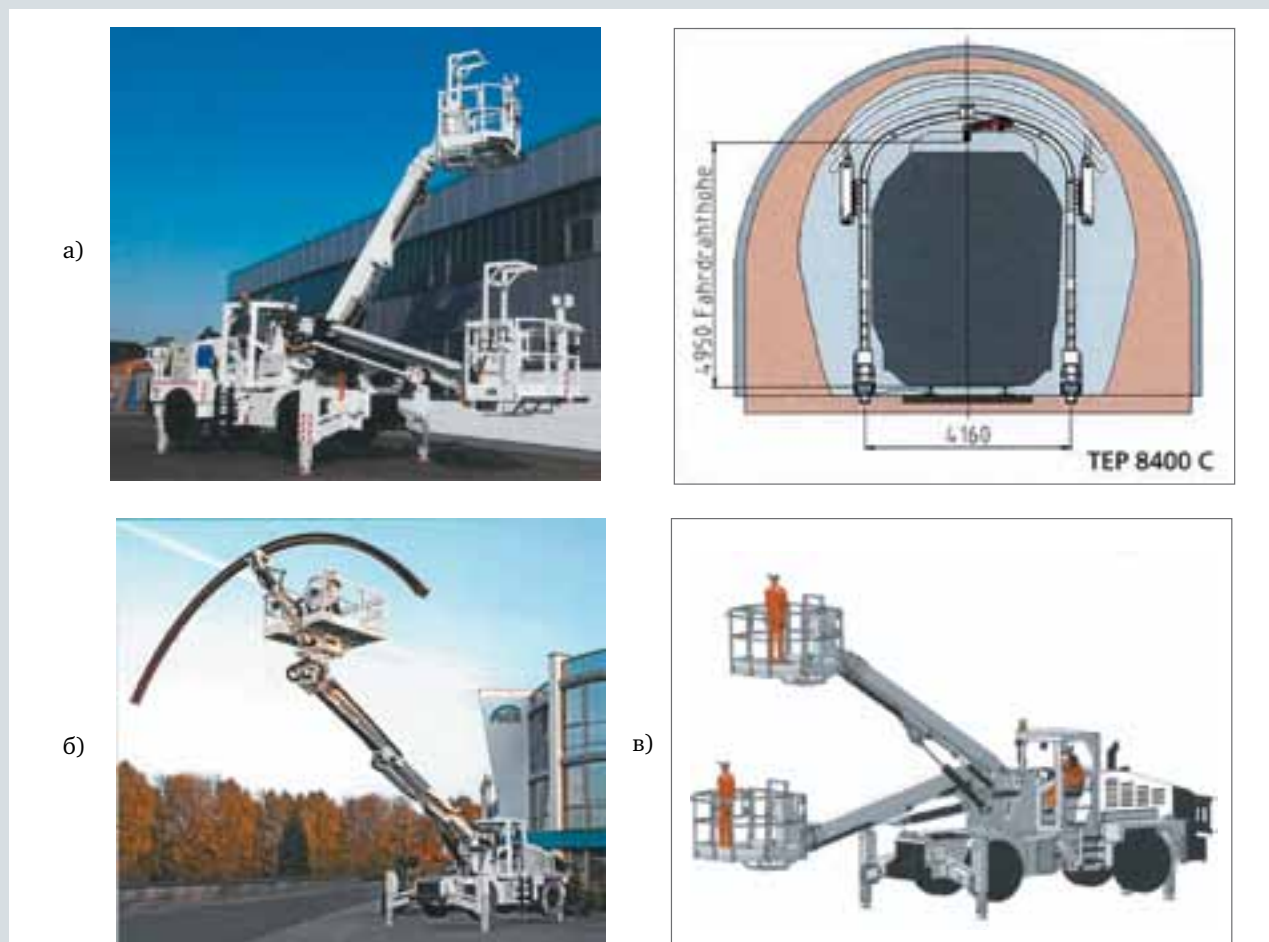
Оборудование фирмы GTA (Германия): а) для расширения тоннелей без перерыва движения транспорта; б) для монтажа крепи; в) подъемные платформы
